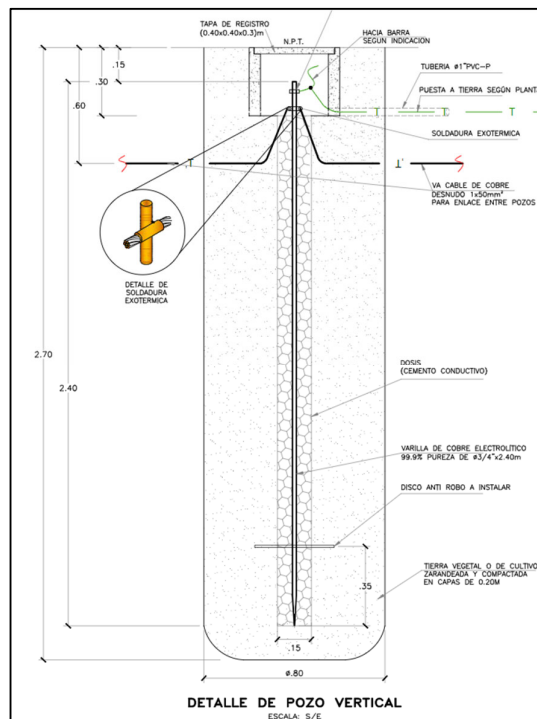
Plano de Detalle de Excavación de pozo de sistema puesta a tierra
